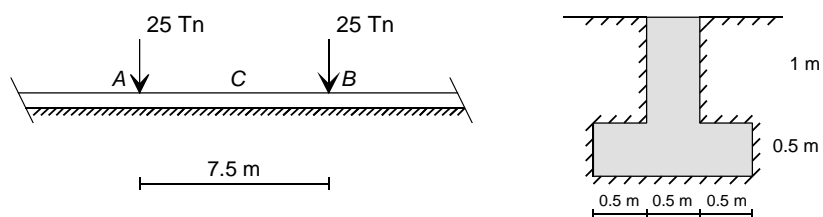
Viga infinita en fundación elástica con dos cargas puntuales.
